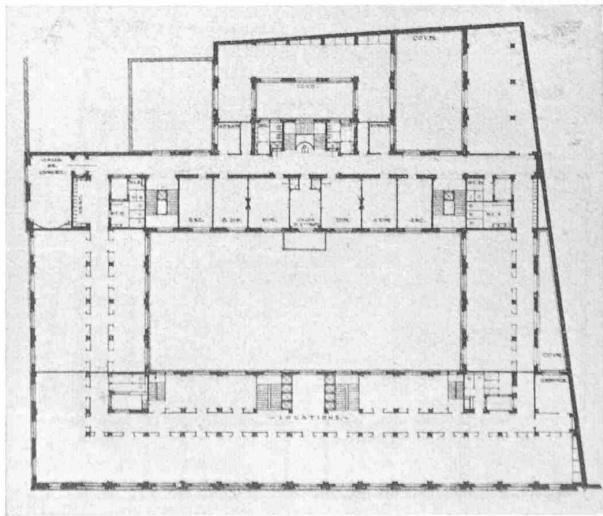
Obergeschoss-Grundriss. — 1:800.
